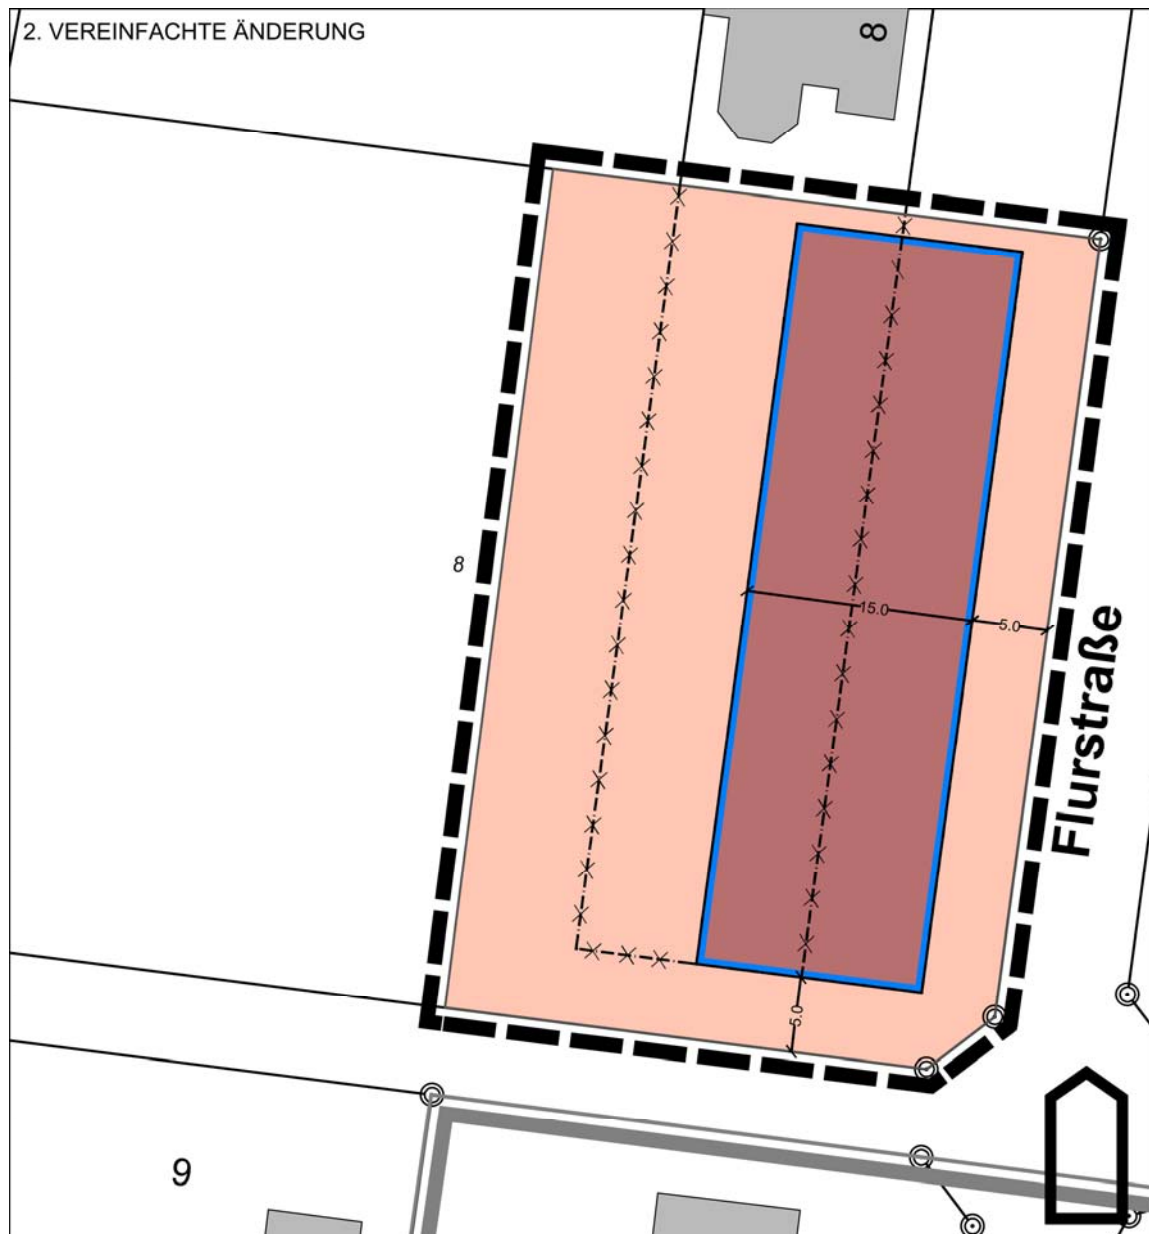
Bebauungsplan F 1, 2. Änderung (ohne Maßstab)
